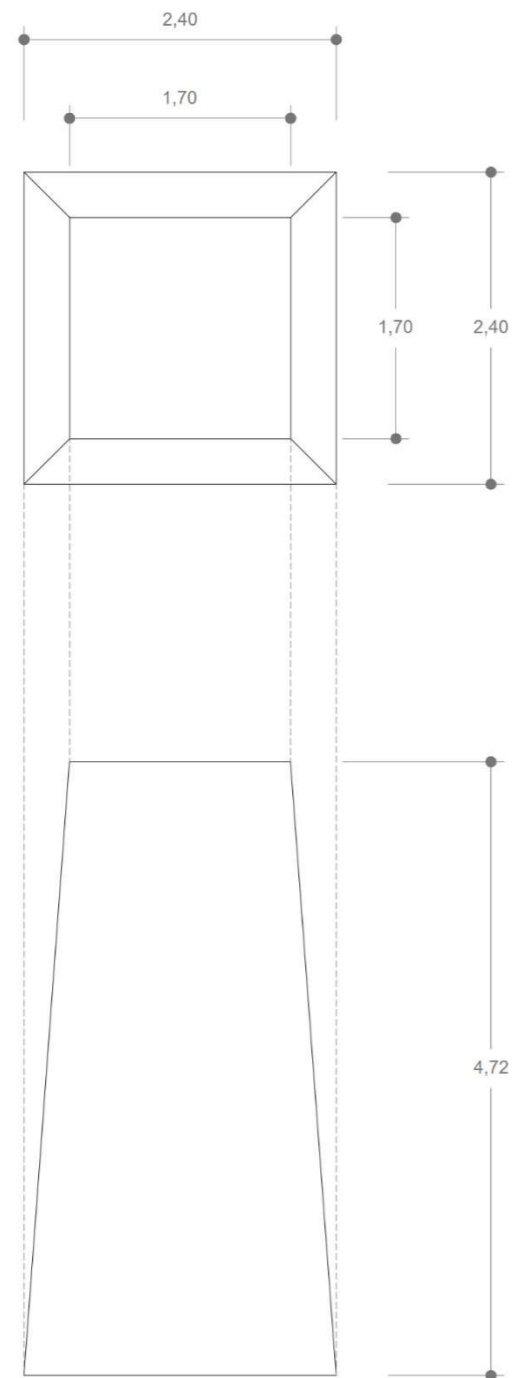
Vista en planta y alzado de las pilas (fuente: elaboración propia)
